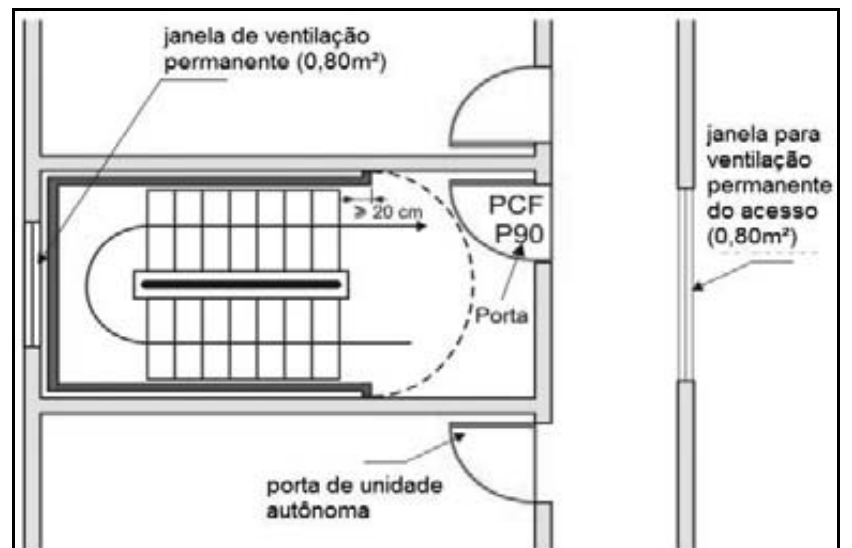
Ventilação da escada enclausurada protegida e seu acesso
